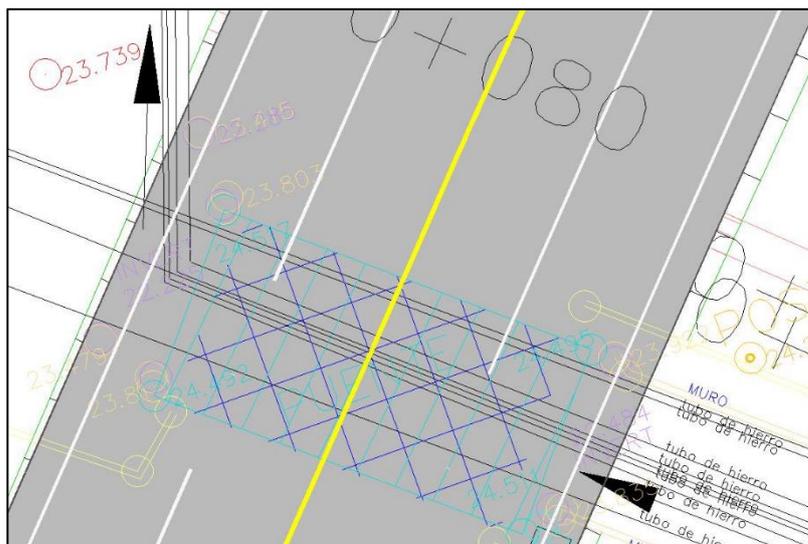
Vista en planta de Alcantarilla en abscisa 0+070.
